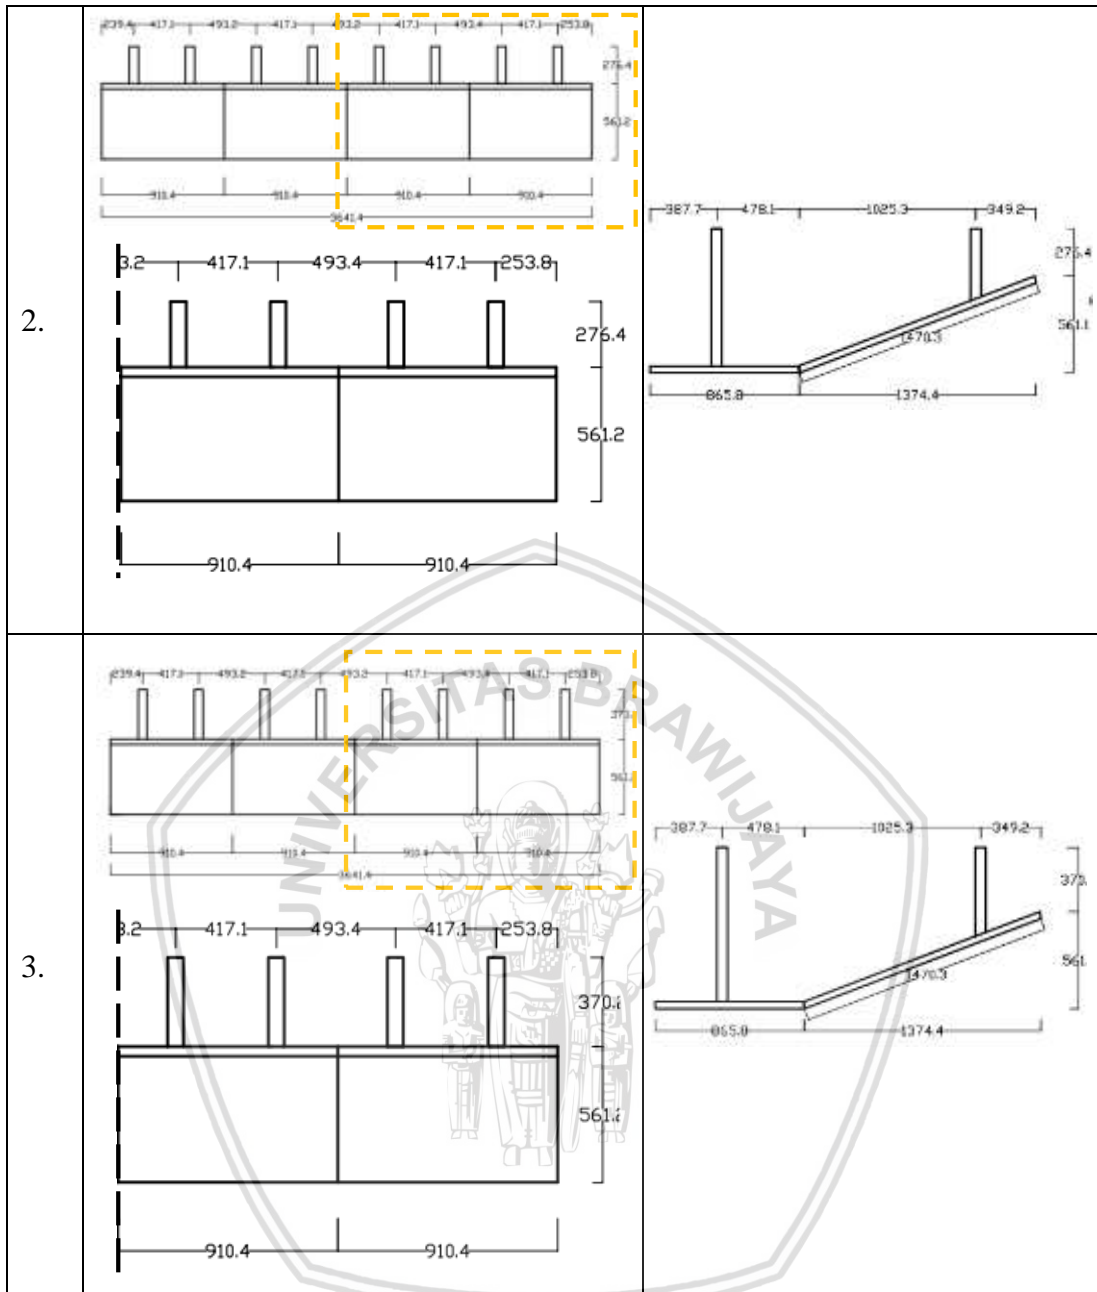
Rekomendasi desain penambahan elemen gantung pada plafond di meeting room
